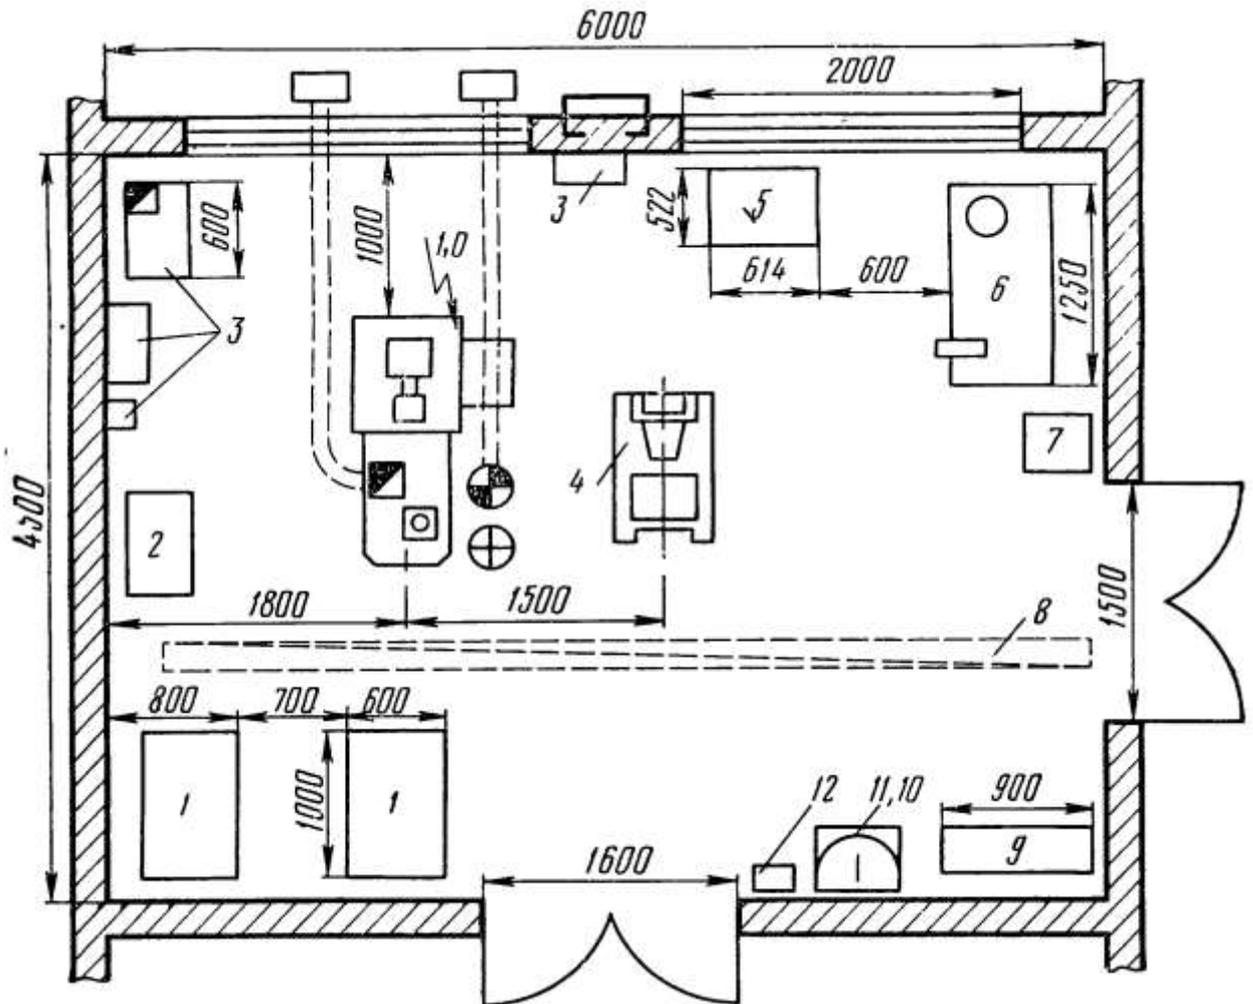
Планировка рабочего места слесаря-обкатчика:
